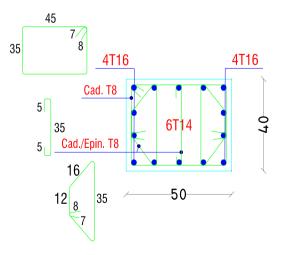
coupe Ferraillage des poteaux (50×40) cm².
